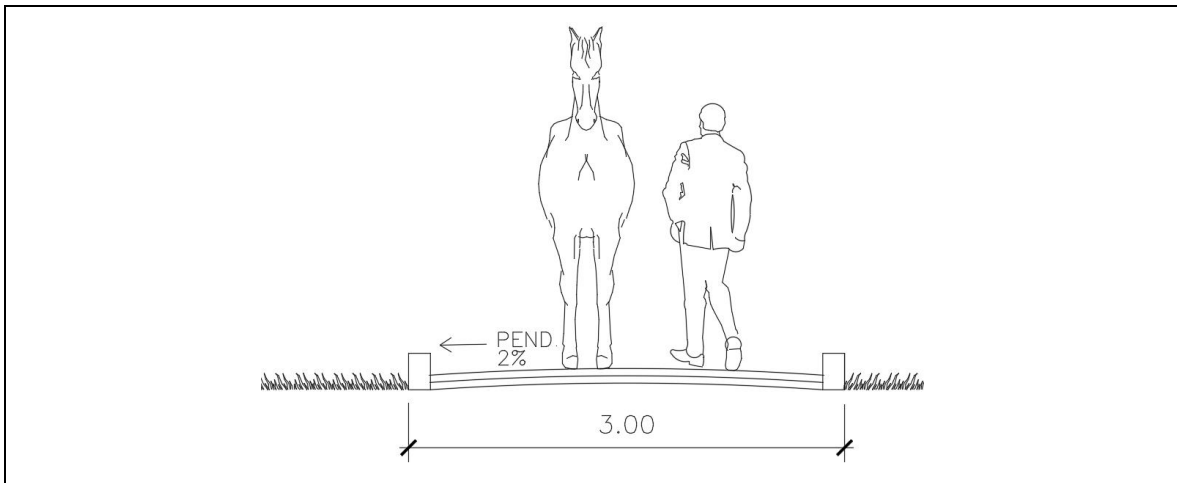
Sección vial en vialidades peatonales (andadores) tipo "C"
